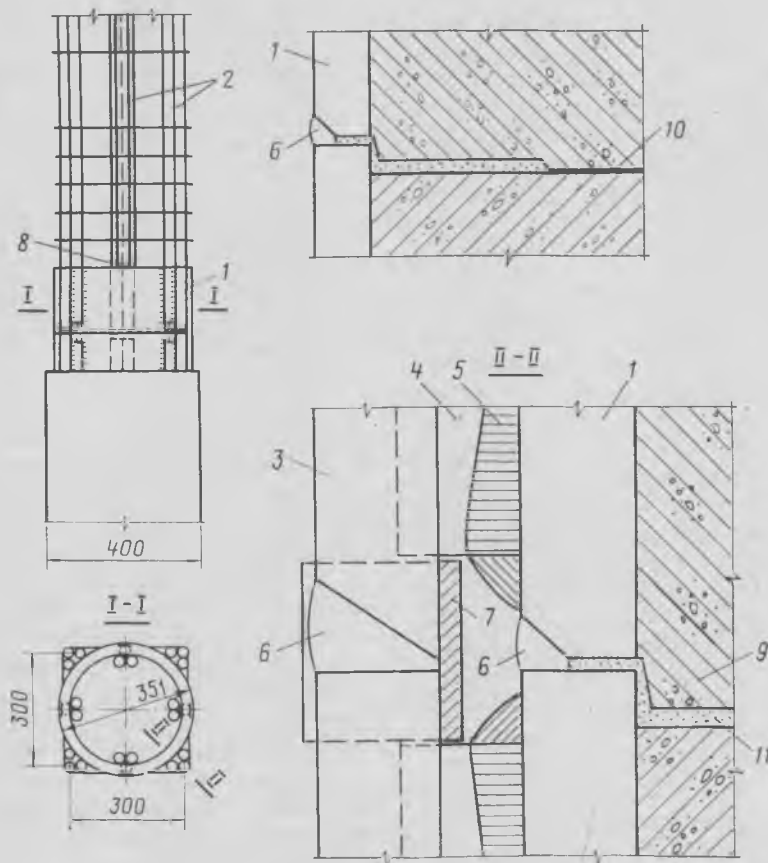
Трубобетонный стык колонн с блокированной арматурой
